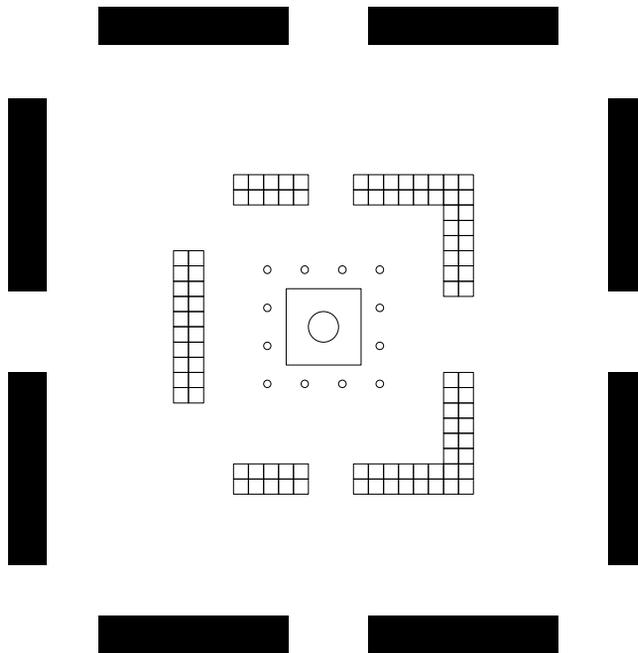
Plano del proyecto para aumentar el número de puestos en la plaza del Volador, elaborado por los arquitectos José del Mazo y Damián Ortiz, 1792.
